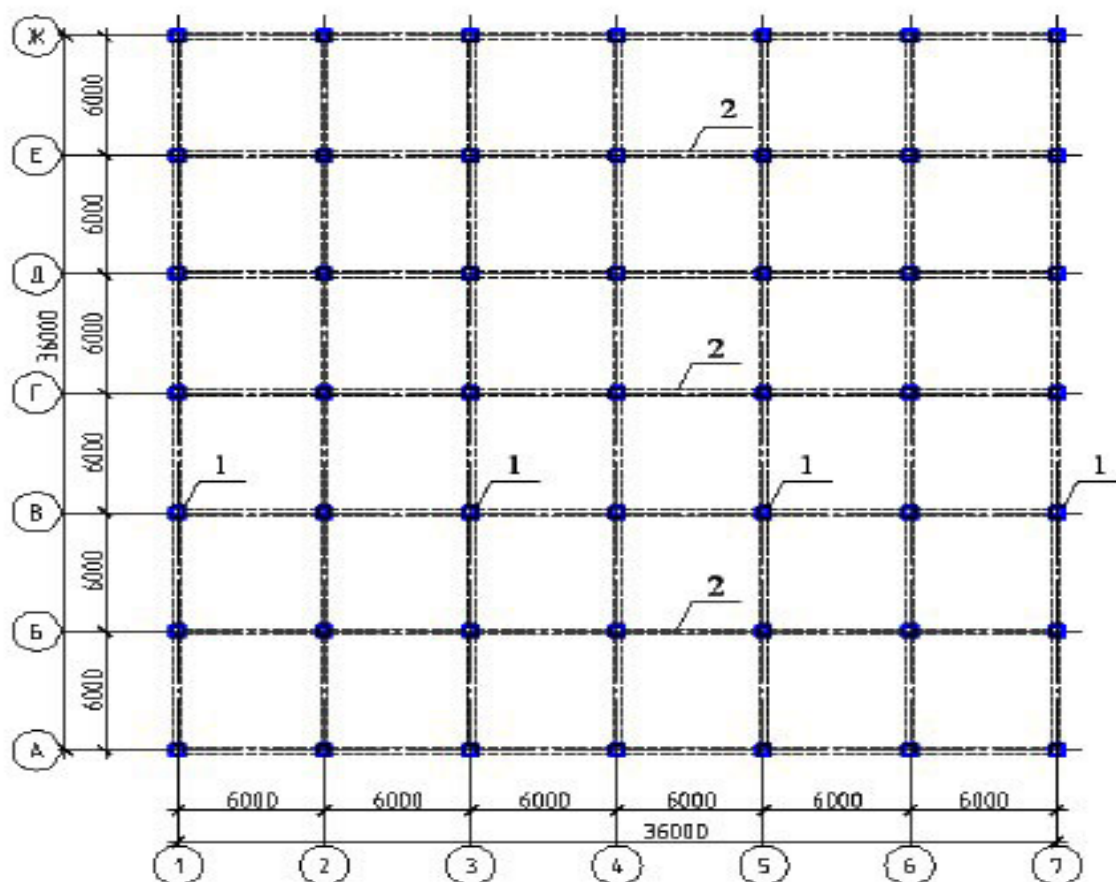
План типового этажа. 1– колонны, 2– диафрагмы перераспределяющего блока (только на 13-ом этажа)
